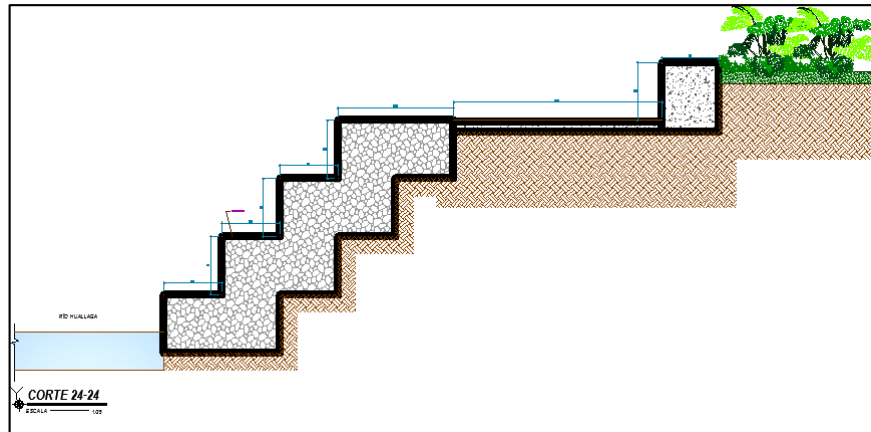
Corte detallado de los gaviones y su disposición escalonada.
